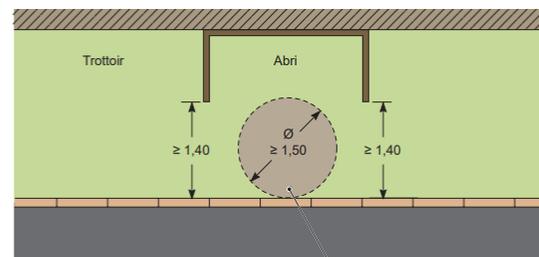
Implantation d'un arrêt de transport collectif sur un trottoir étroit.
